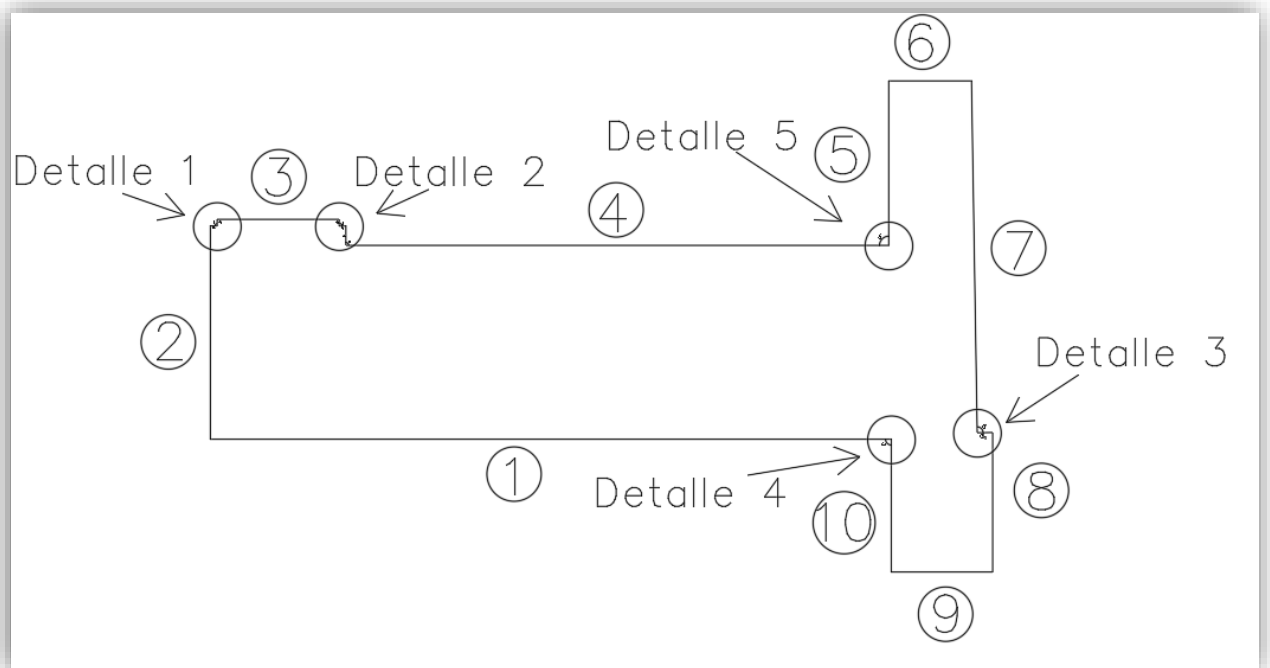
Croquis en AutoCAD del ala sur de la facultad. Apoyo para la parte 2.
